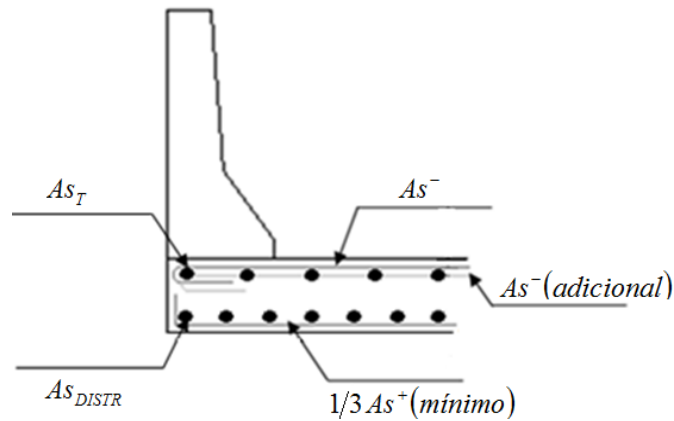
Armadura total en el voladizo del tablero [12]
